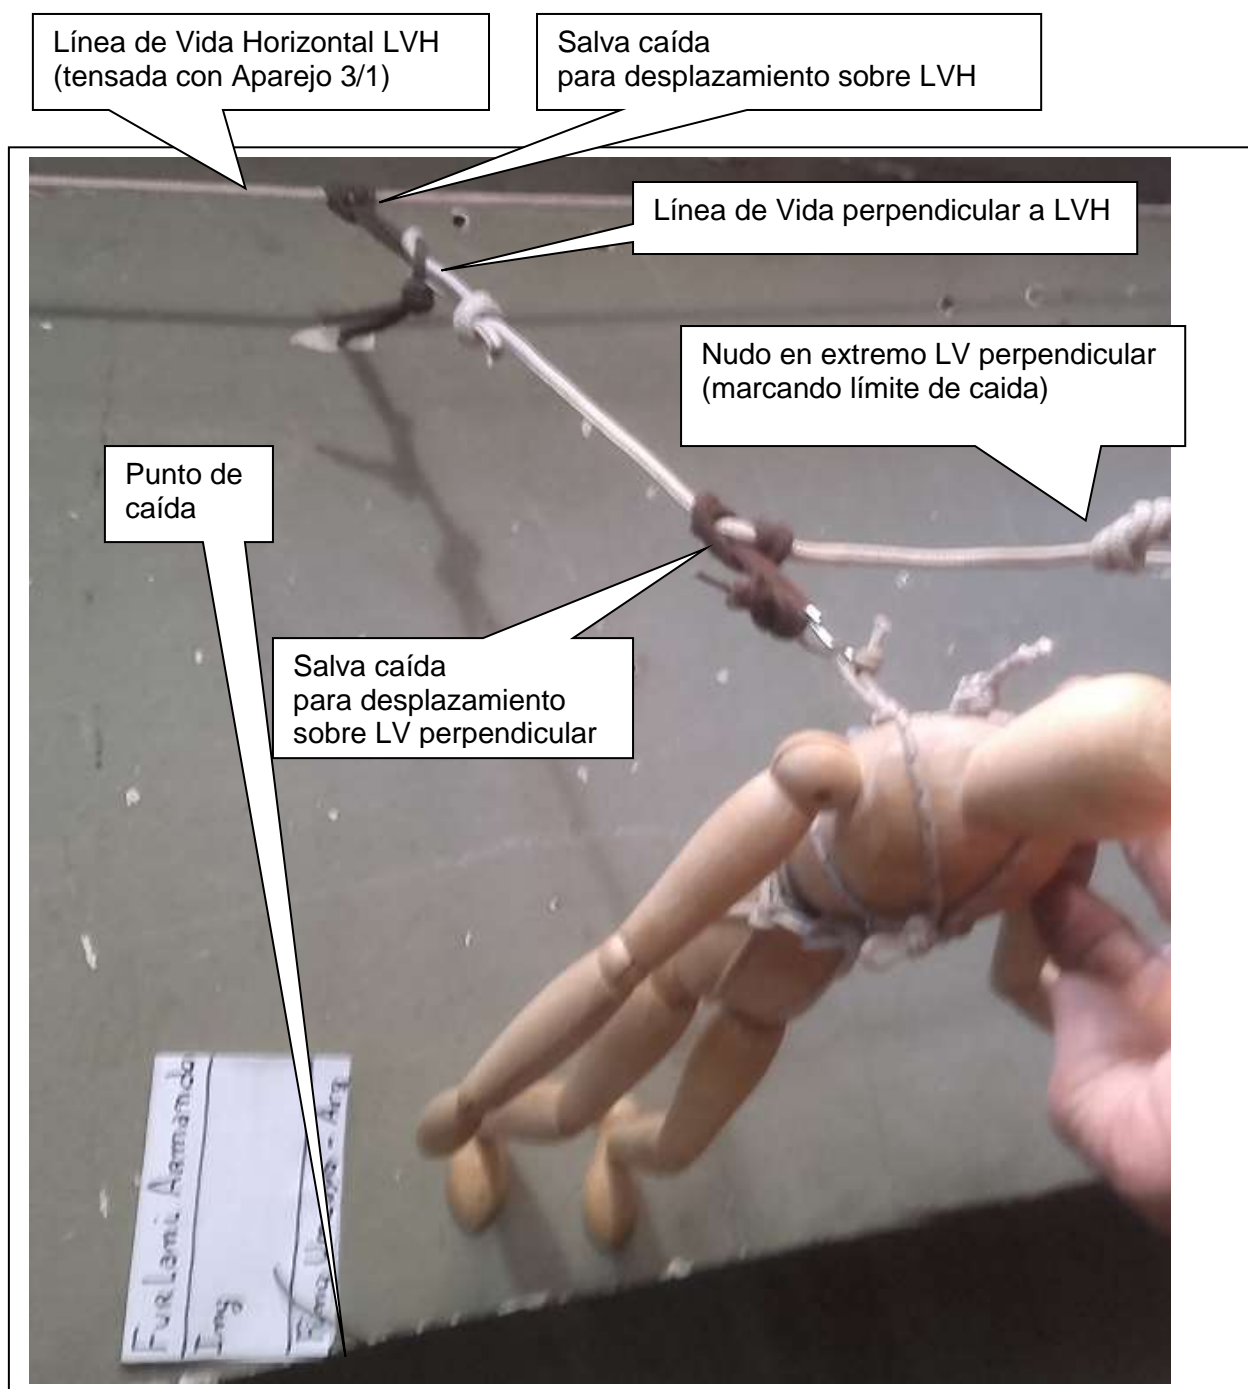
TA- Restricción de movimiento (impide llegar al punto de caída) en el plano
